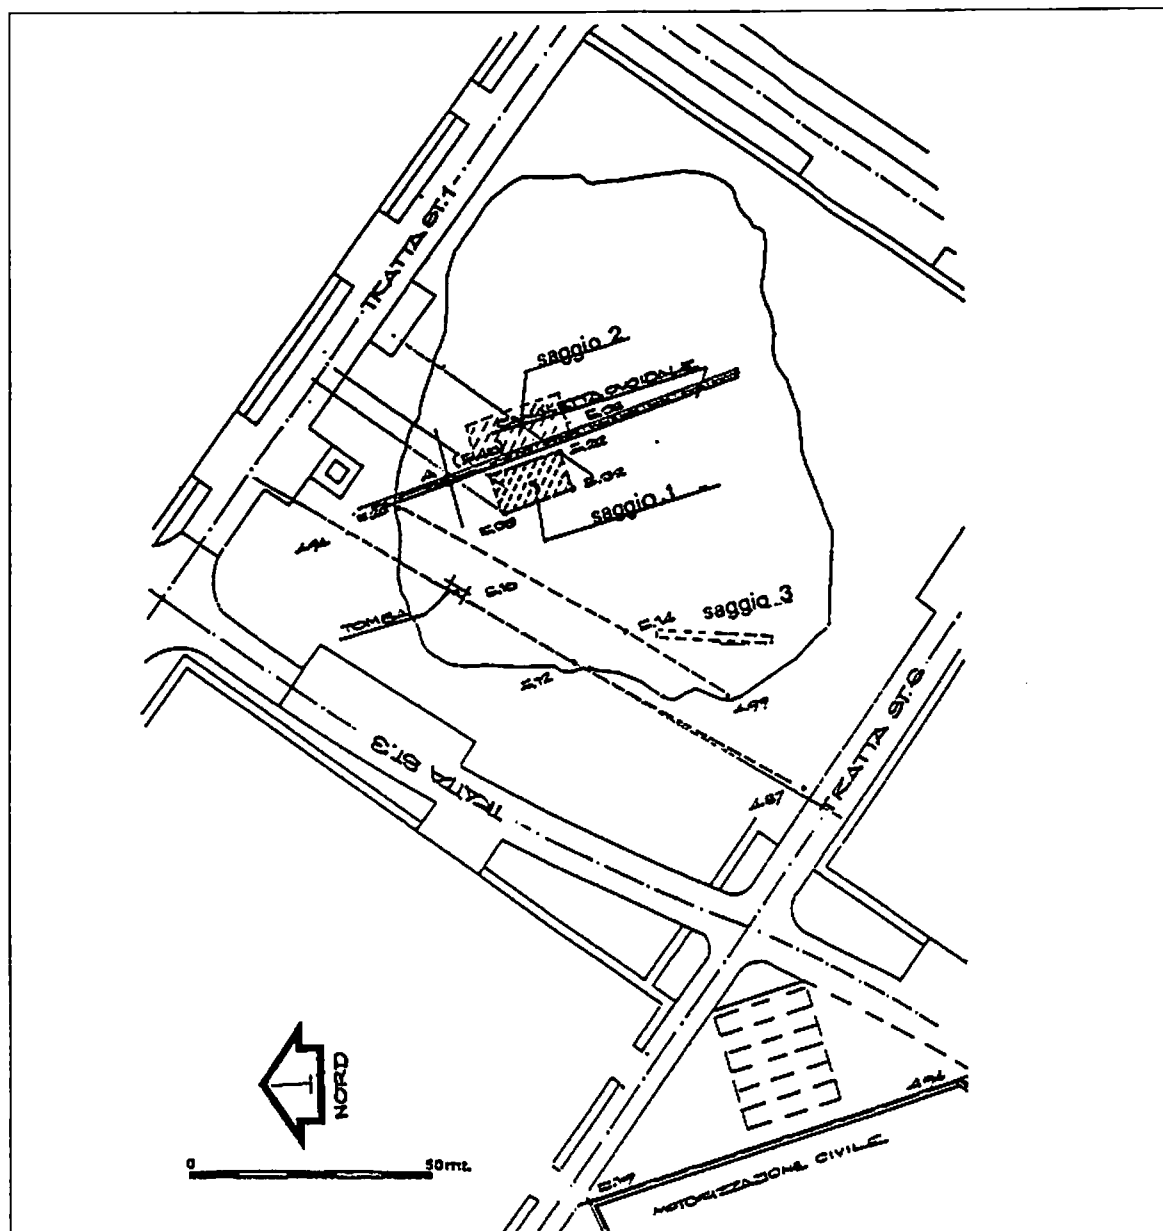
Codroipo, località Piccola di Moro. Planimetria dell'area oggetto di indagine.
